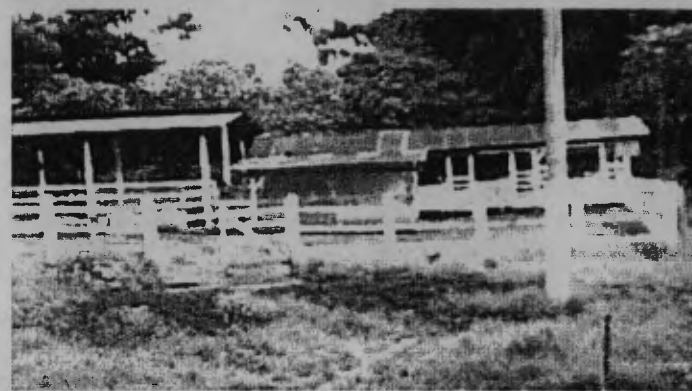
FACHADA SUR, ESTADO ANTERIOR
